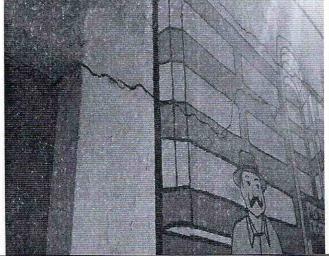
y 6. Presencia de fisuras y grietas en muros de fachada y muros perimetrales.
